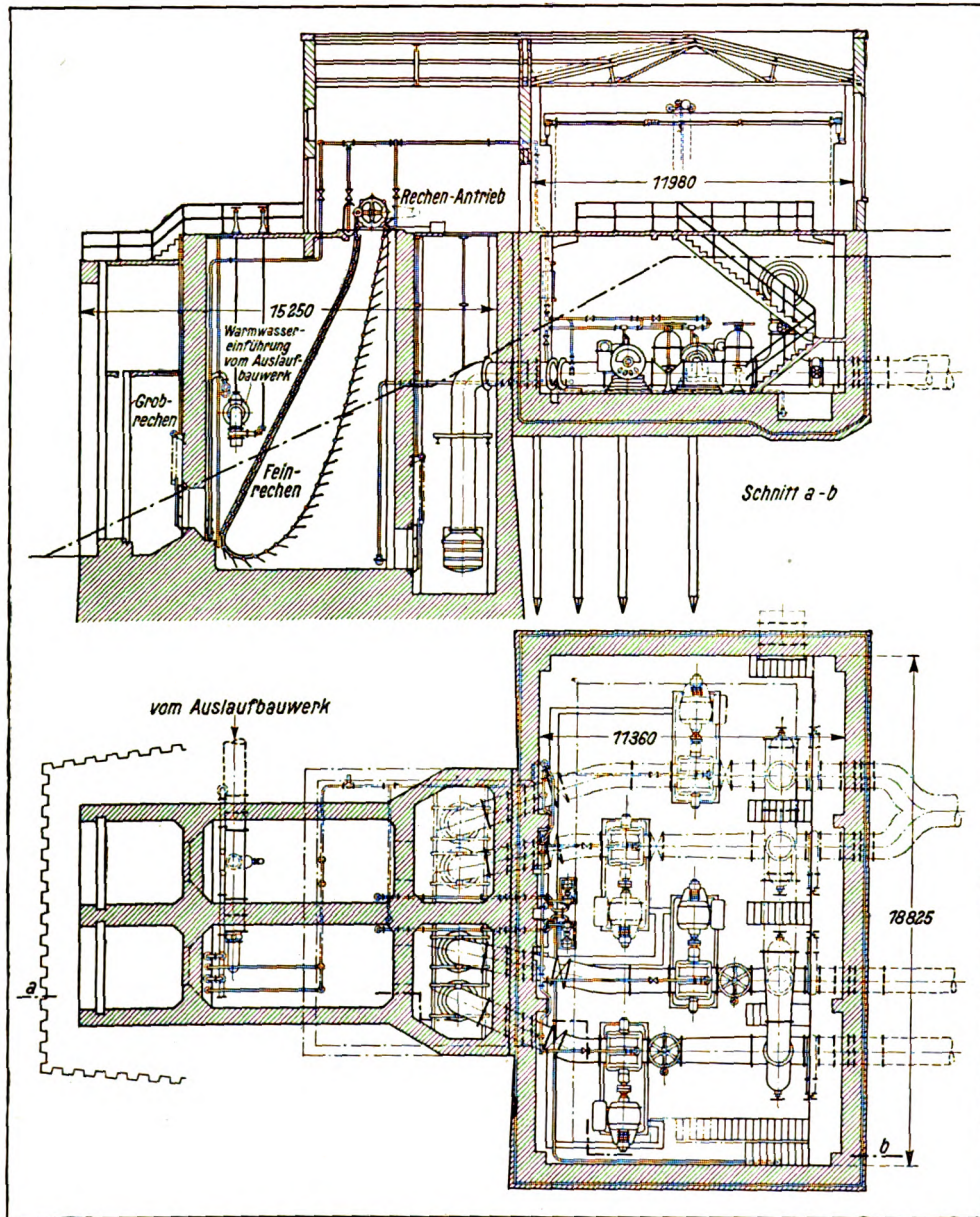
Schnitt und Grundriß des Einlaufbauwerkes.
